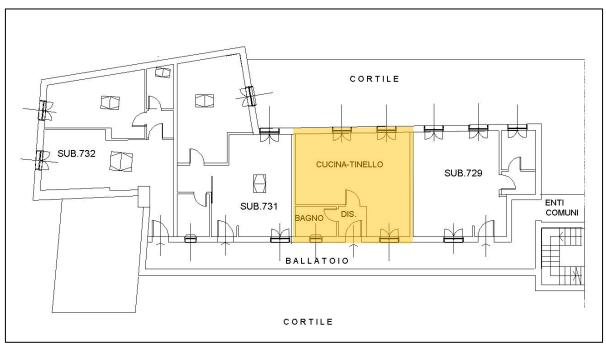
Planimetria castale del 6.03.2003 - Sub. 730 (Stato dei luoghi rilevato al sopralluogo dell'11.11.2021
